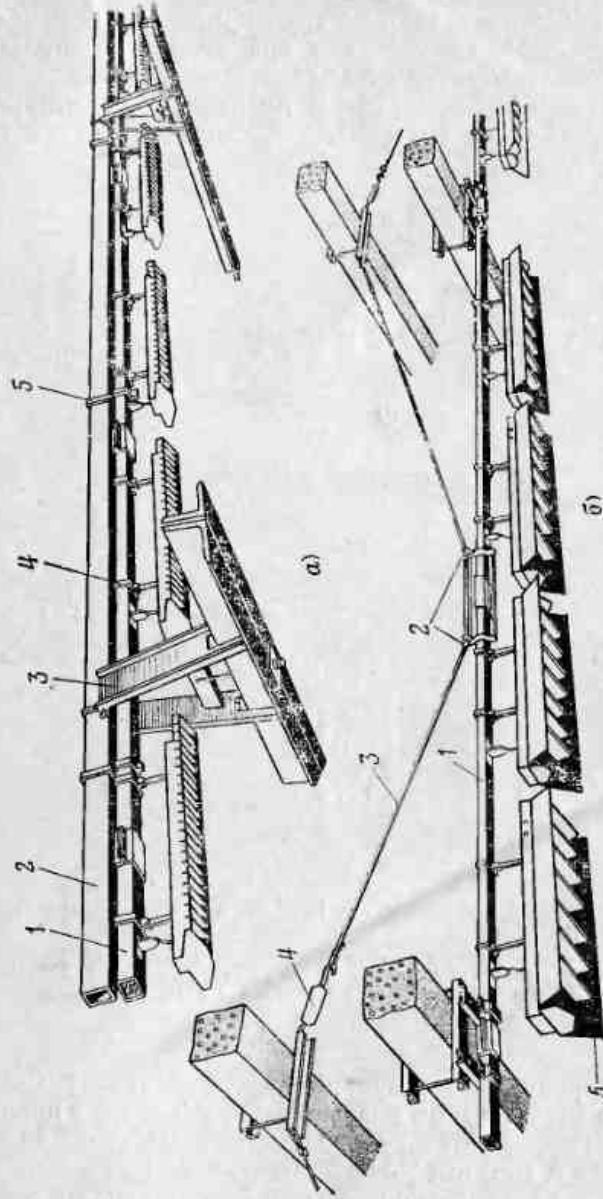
Прокладка шинопроводов ШОС67 поперек ферм.
